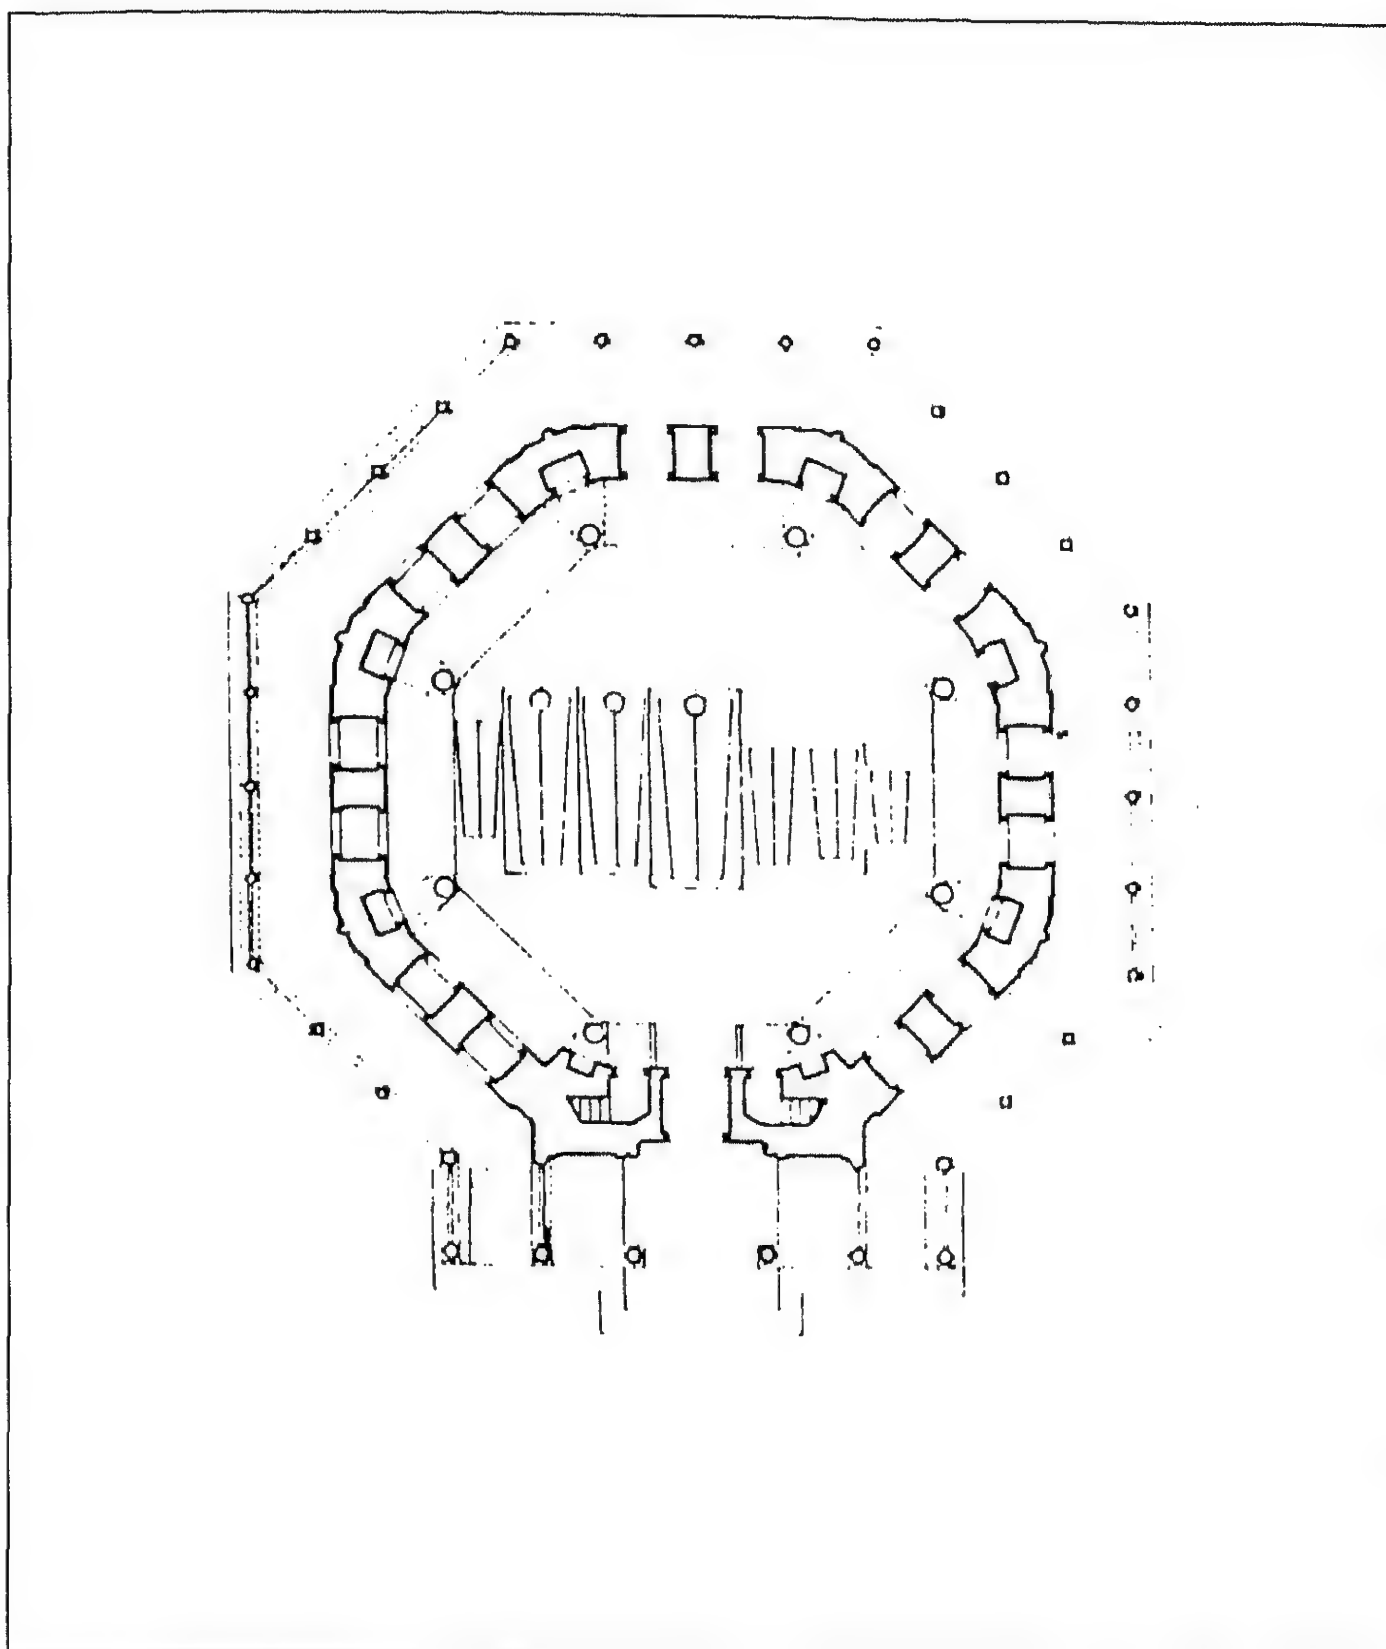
مسقط أفقي لتربة سليم الثاني في مدافن أيا صوفيا بإستانبول (عن : اصلان
